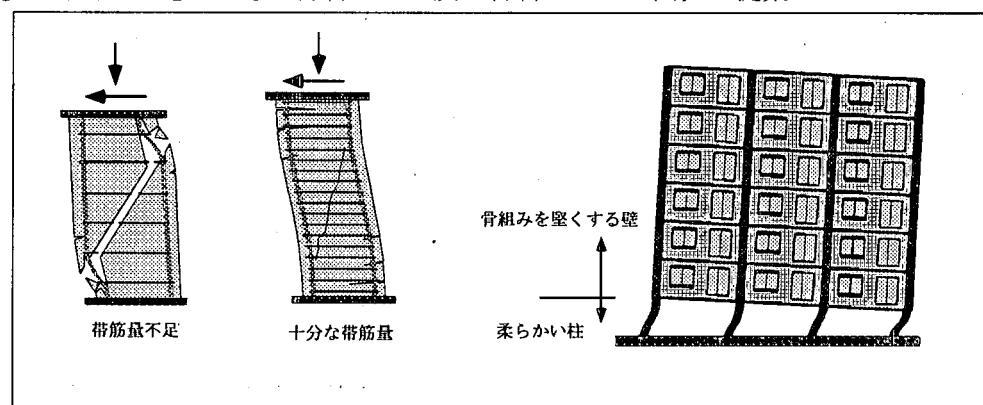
鉄筋コンクリート造建物の破壊挙動
